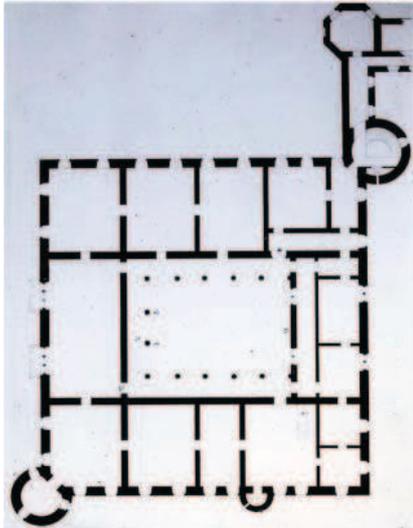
Grundriss Schloss Porcia OG
